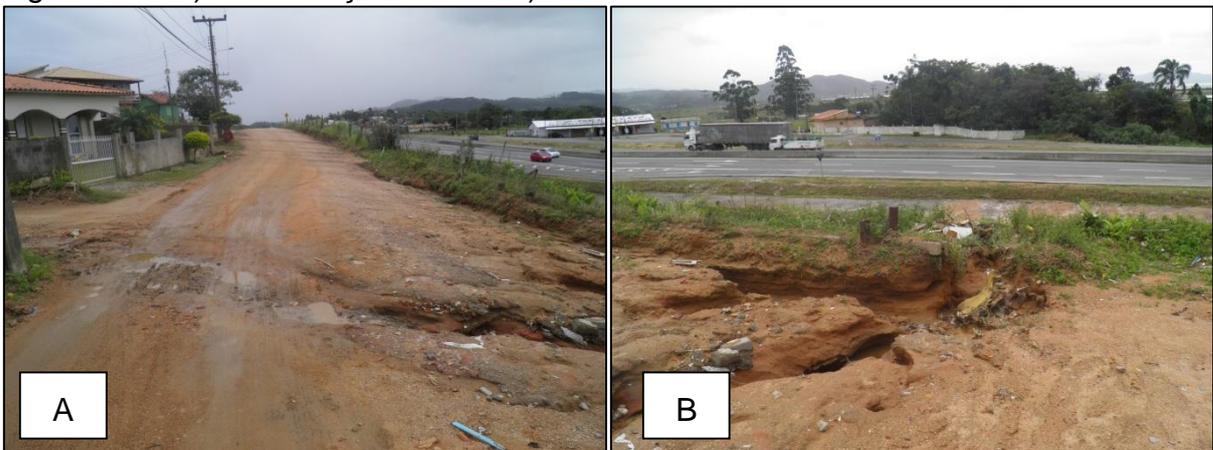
A) Ponto de localização da travessia do córrego. B) o material da via primária sobre a Laje de concreto.
